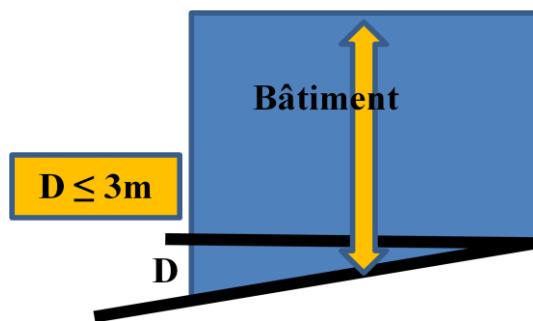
La hauteur d'un bâtiment construit sur une pente
